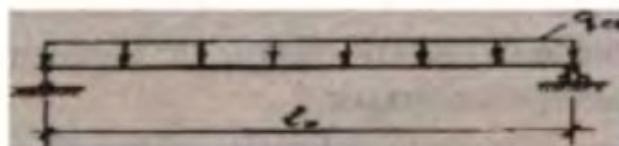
Расчетная схема балки для расчета на монтажные нагрузки
